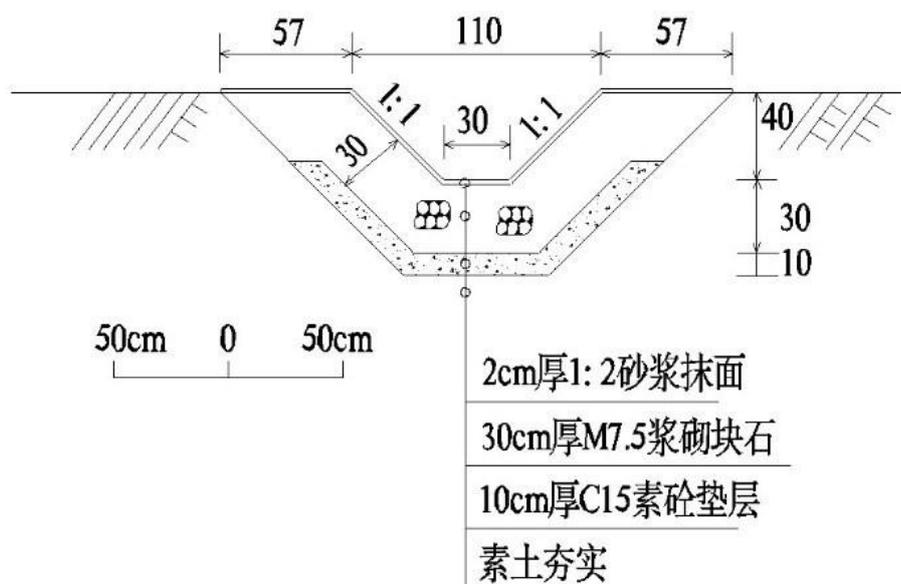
排矸场岸坡、纵向截排水沟断面图
